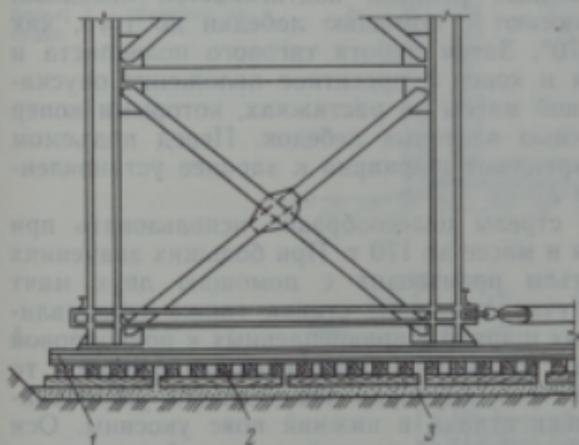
Монтажный стенд для сборки копра в вертикальном положении
